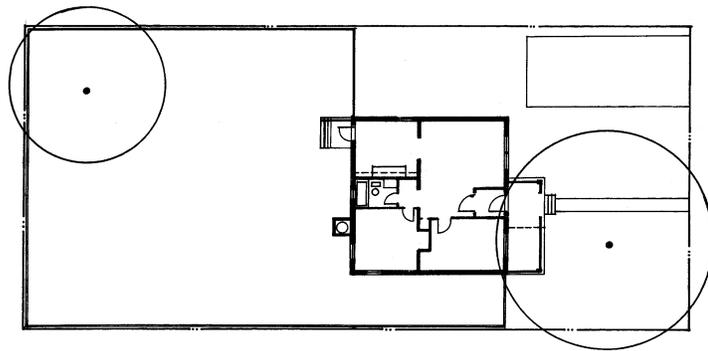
Transformation d'un garage en studio (Friedman, 2002, p. 87).
